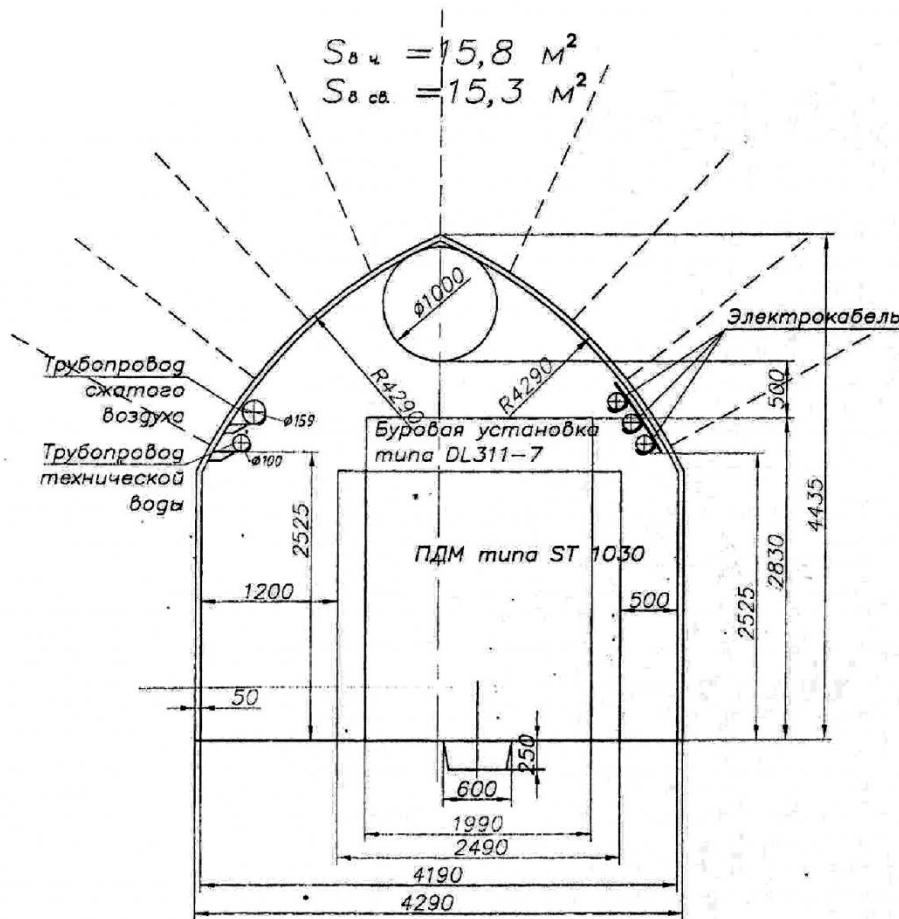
Схема для определения площади поперечного сечения наклонного съезда
